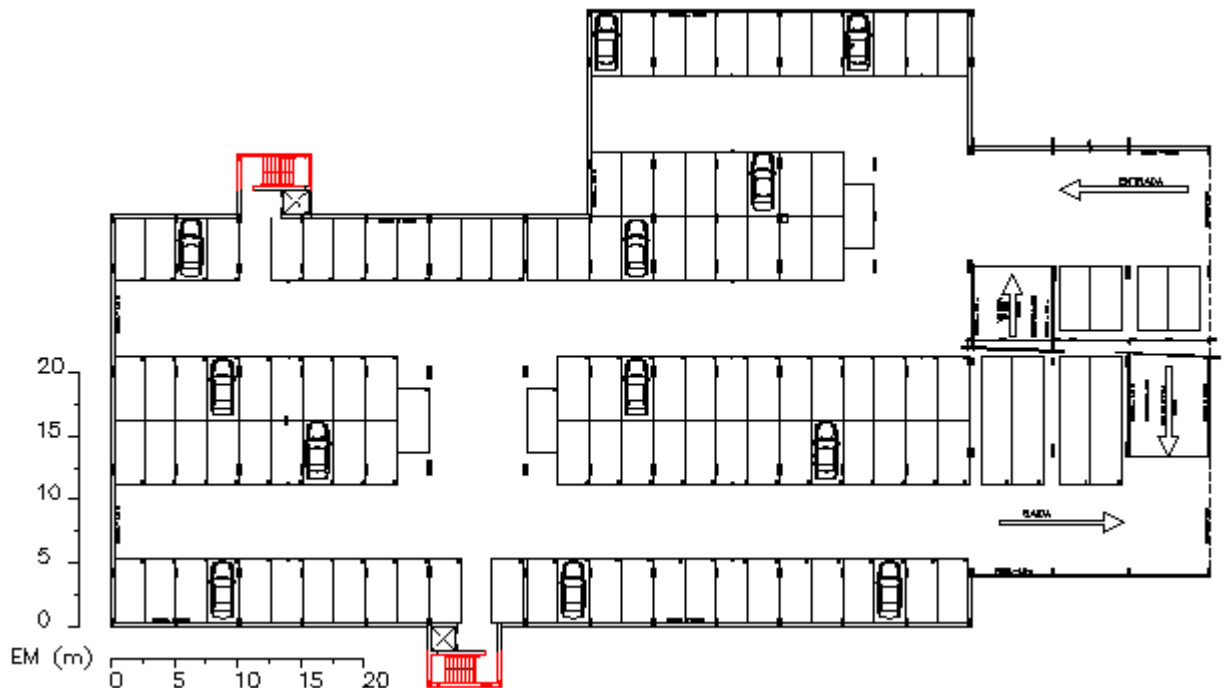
Localização das Escadas Não Enclausuradas (NE) no Pavimento Térreo
